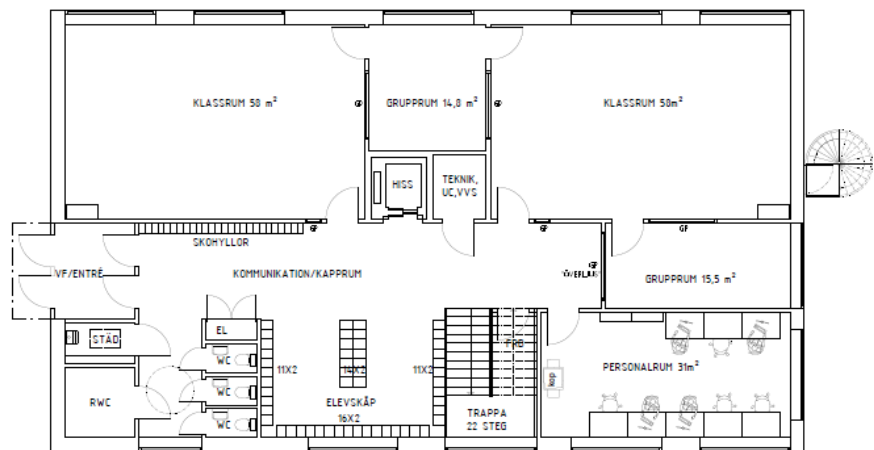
Föreslagen ny byggnad, plan 1 av 2
